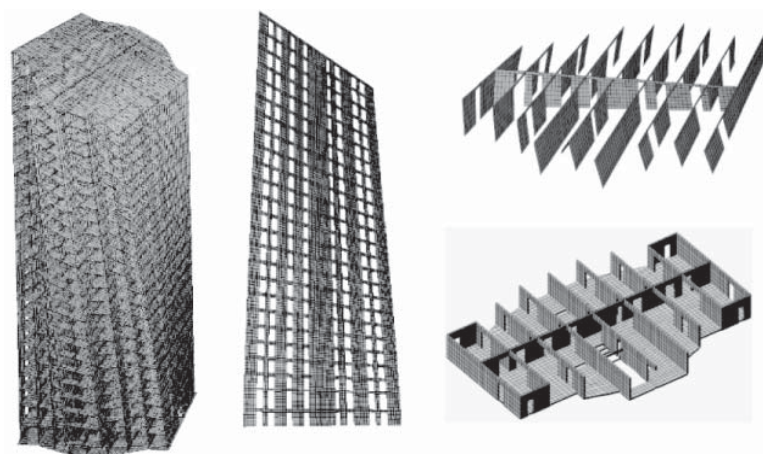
Схема с двумя близко расположенными продольными стенами
